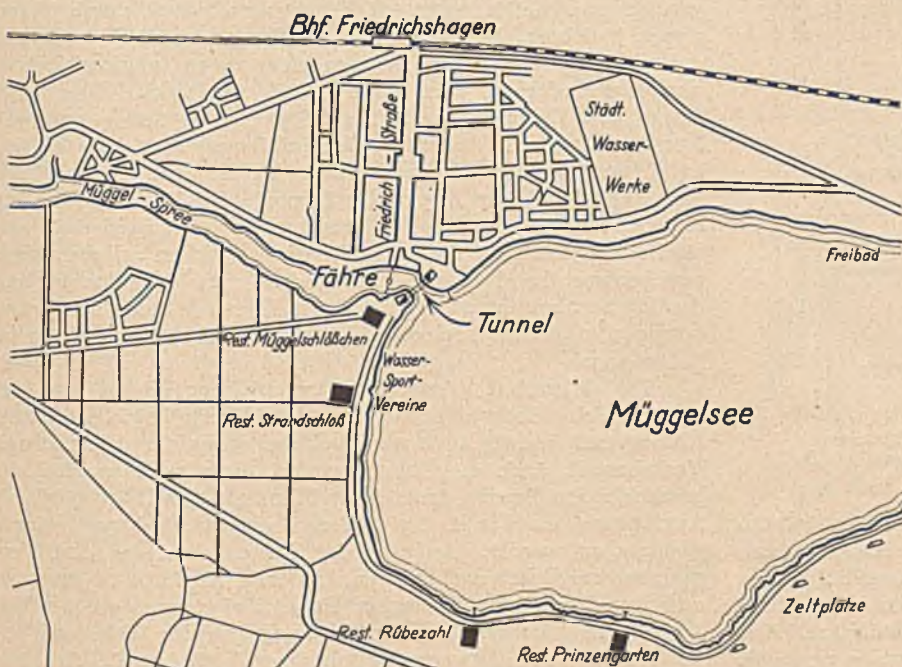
Fußgängertunnel unter der Spree in Berlin-Friedrichshagen. Lageplan mit Umgebung.
